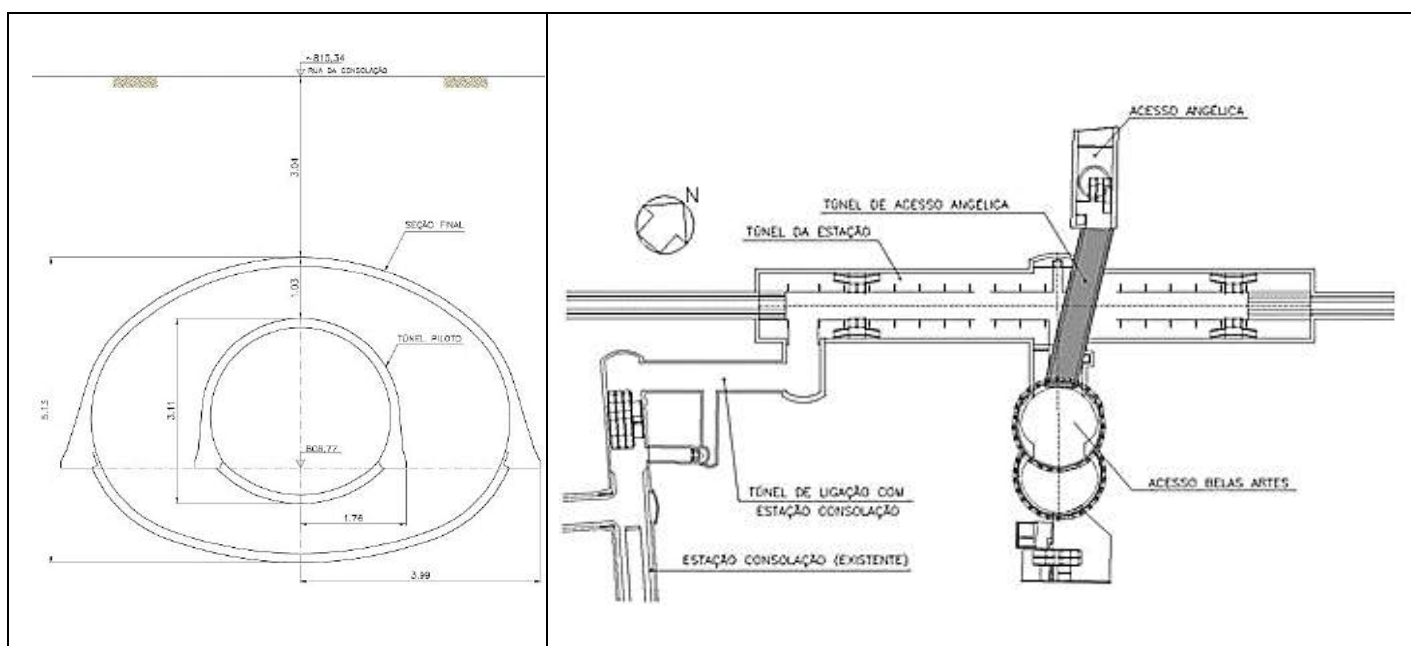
Sobreposição das seções transversais dos túneis piloto e final (à esquerda) e layout em planta do túnel Angélica entre os acessos principal e secundário da estação Paulista da Linha 4 - Amarela (à direita).
